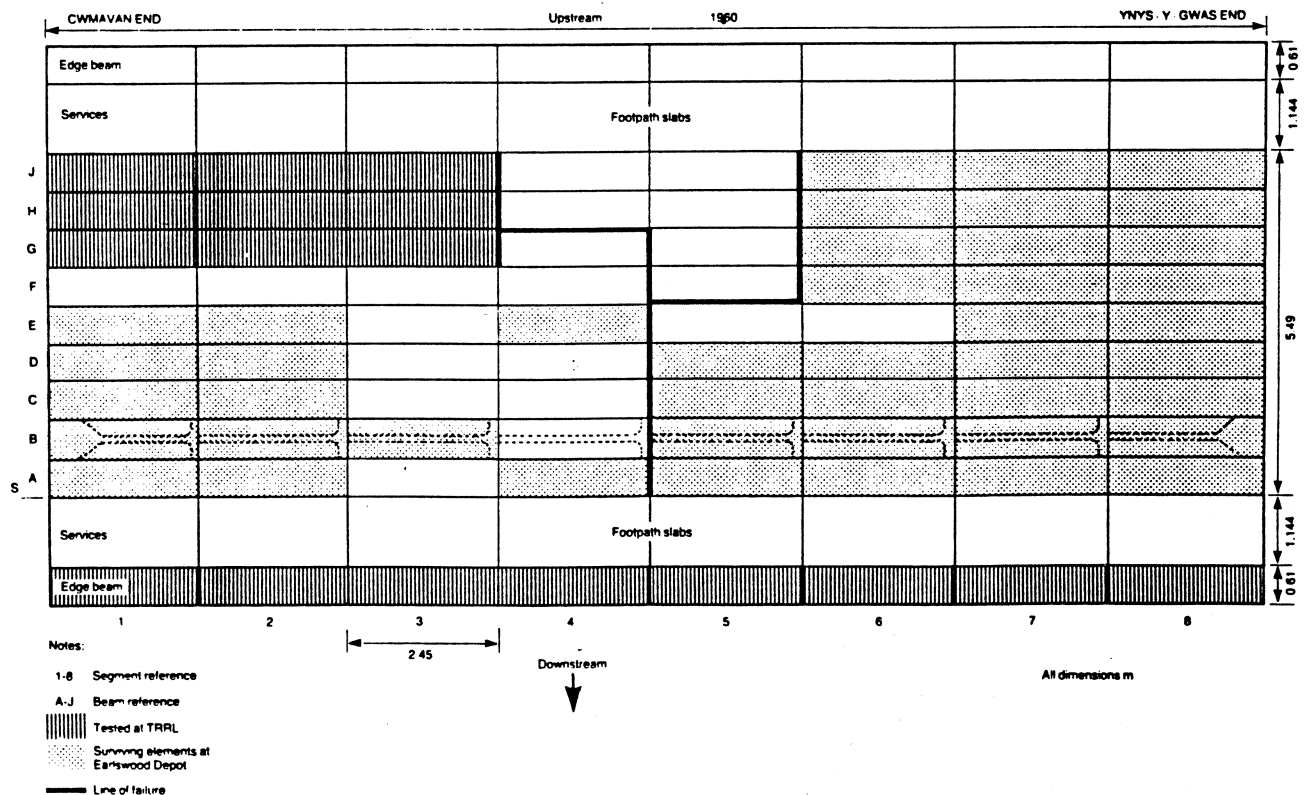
Ynys-y-Gwas-Brücke, Grundriss mit Angabe der längs- und quer-verlaufenden Mörtelfugen zwischen den Trägerelementen und Bruchlinie (Line of failure)
